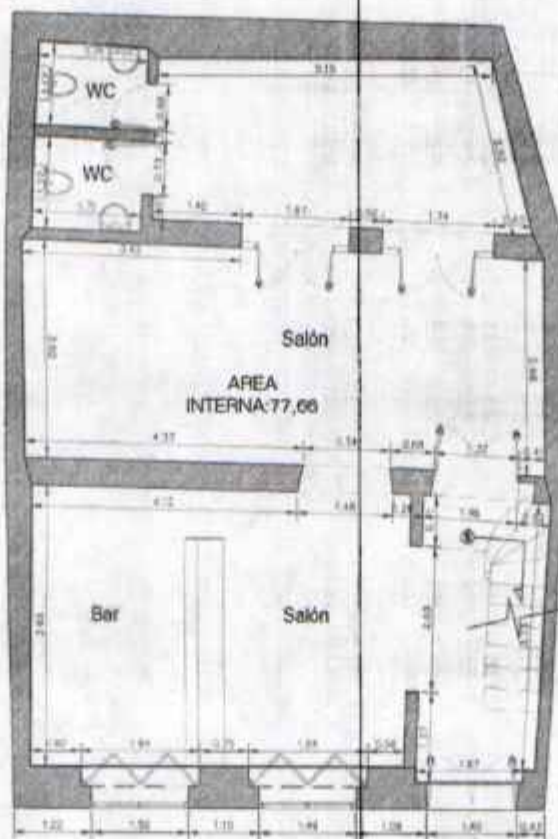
Plano RESTAURANTE JUANA ICACO - Área privada.
